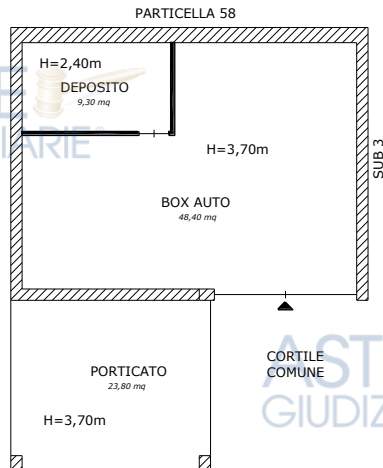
planimetria del porticato, del deposito e del box auto al piano terra
